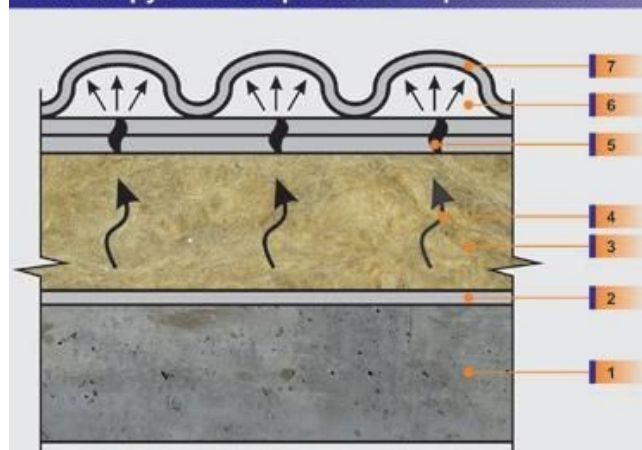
Разрез плоской кровли после обычной реконструкции (наклейка нового гидроизоляционного ковра).
